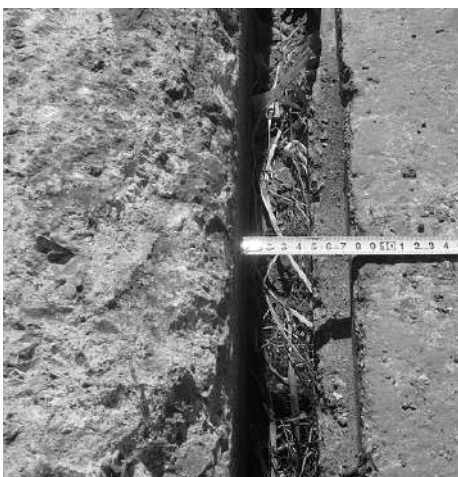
諏訪下地区岸壁 (-5.5m)
